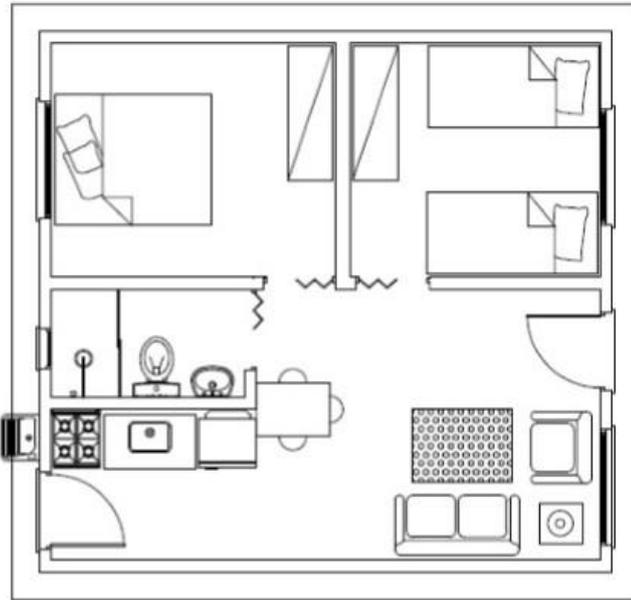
Planta Baixa Mobiliada – PAC-Anglo.
